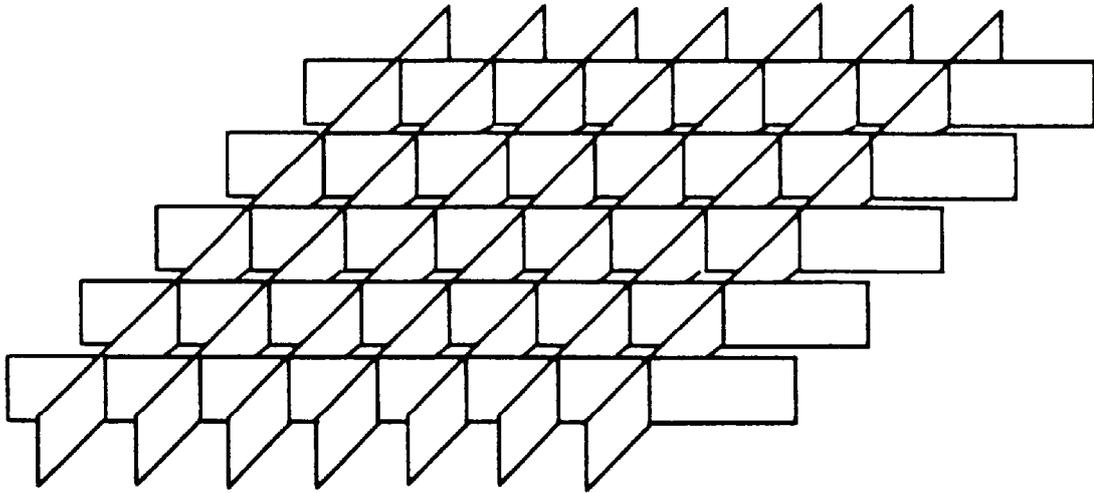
Beispiel für eine Waben- und Gitterdecke (weitere Ausführungen sind möglich)
